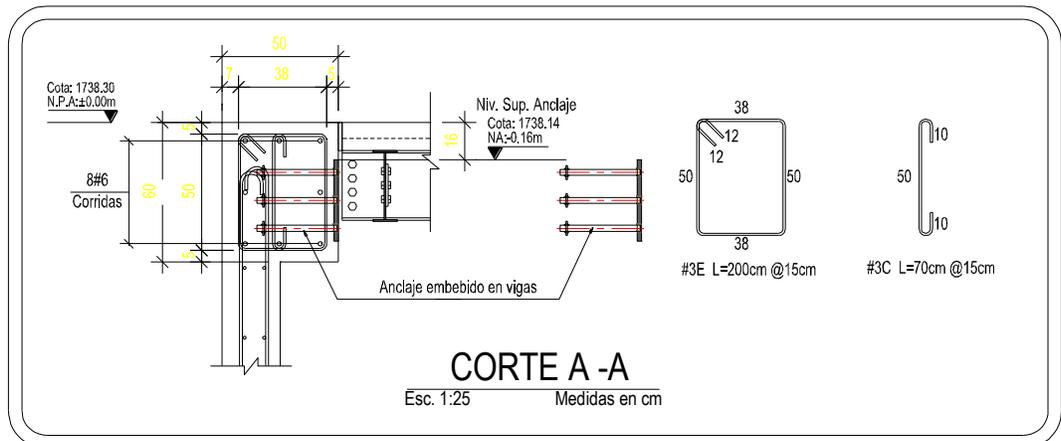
Corte transversal viga corona (Fuente: Departamento de diseño Metálicas e Ingeniería S.A.)
